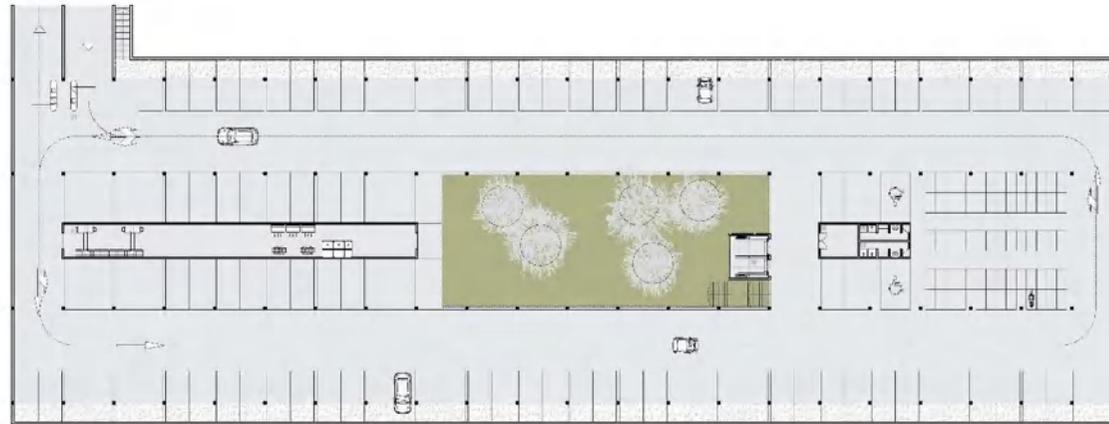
Planta baixa quinto pavimento do novo bloco Campus Cabral – UFPR (sem escala)
